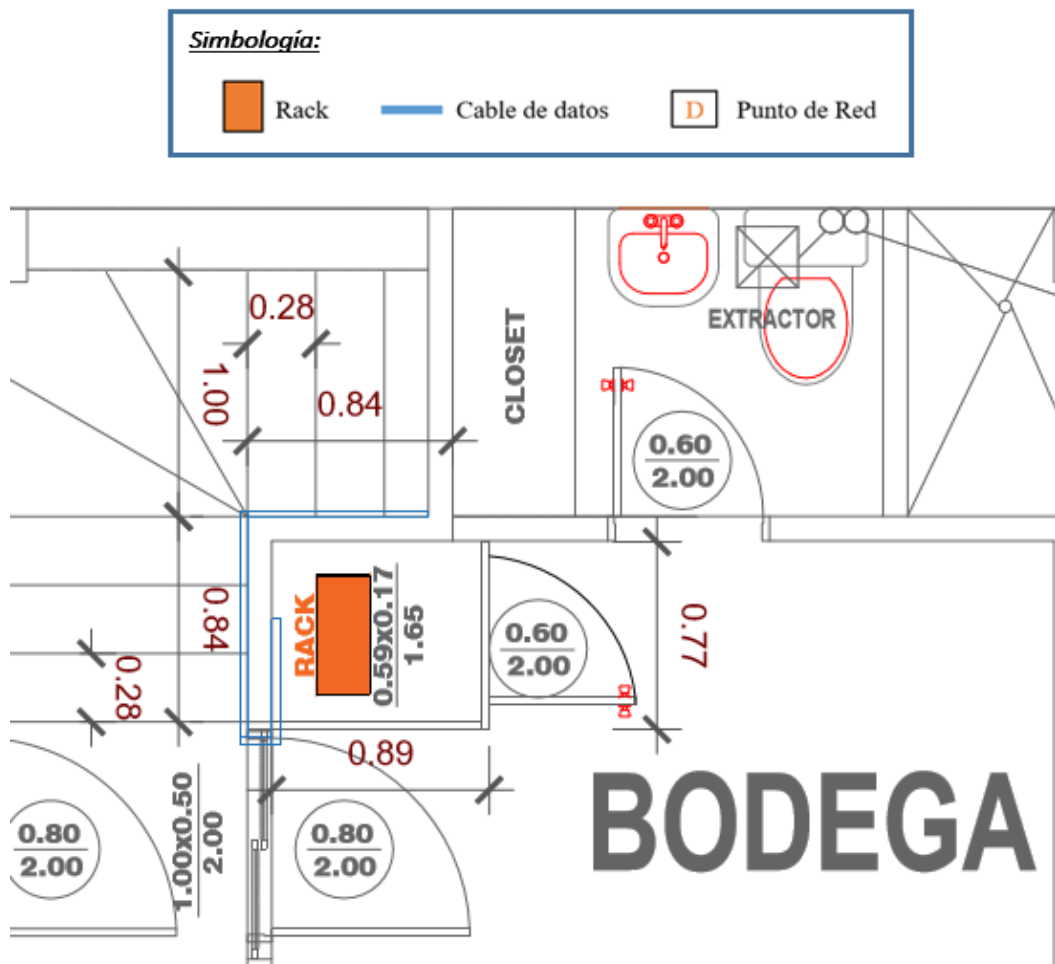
3: Plano de cableado para la corporación, Planta baja, Bodega y Cuarto de Telecomunicaciones.
